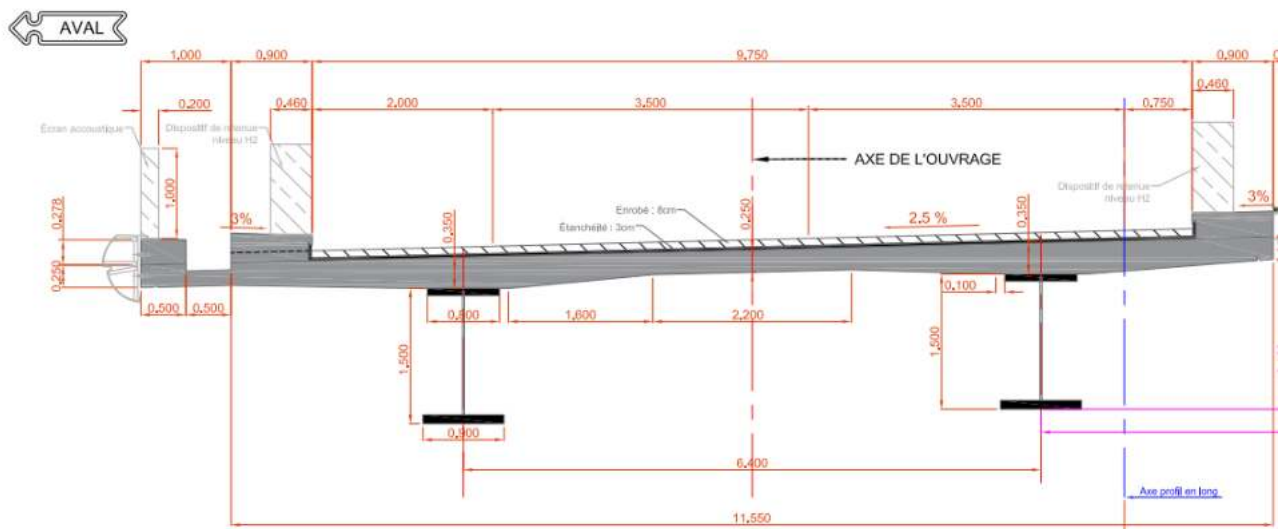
Coupe transversale de l'ouvrage de Doublement.
